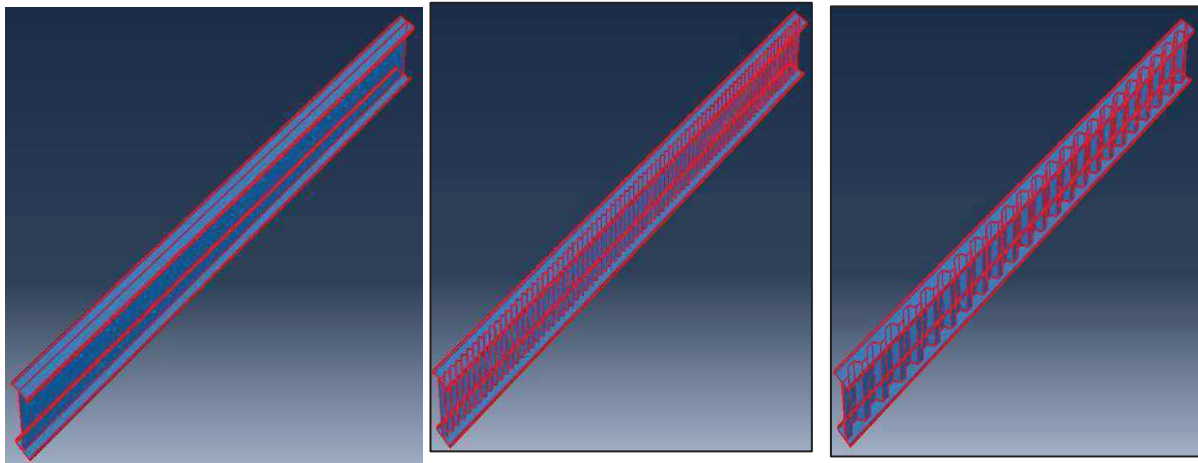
Assemblage des poutres de forme I avec différentes section d'âme
